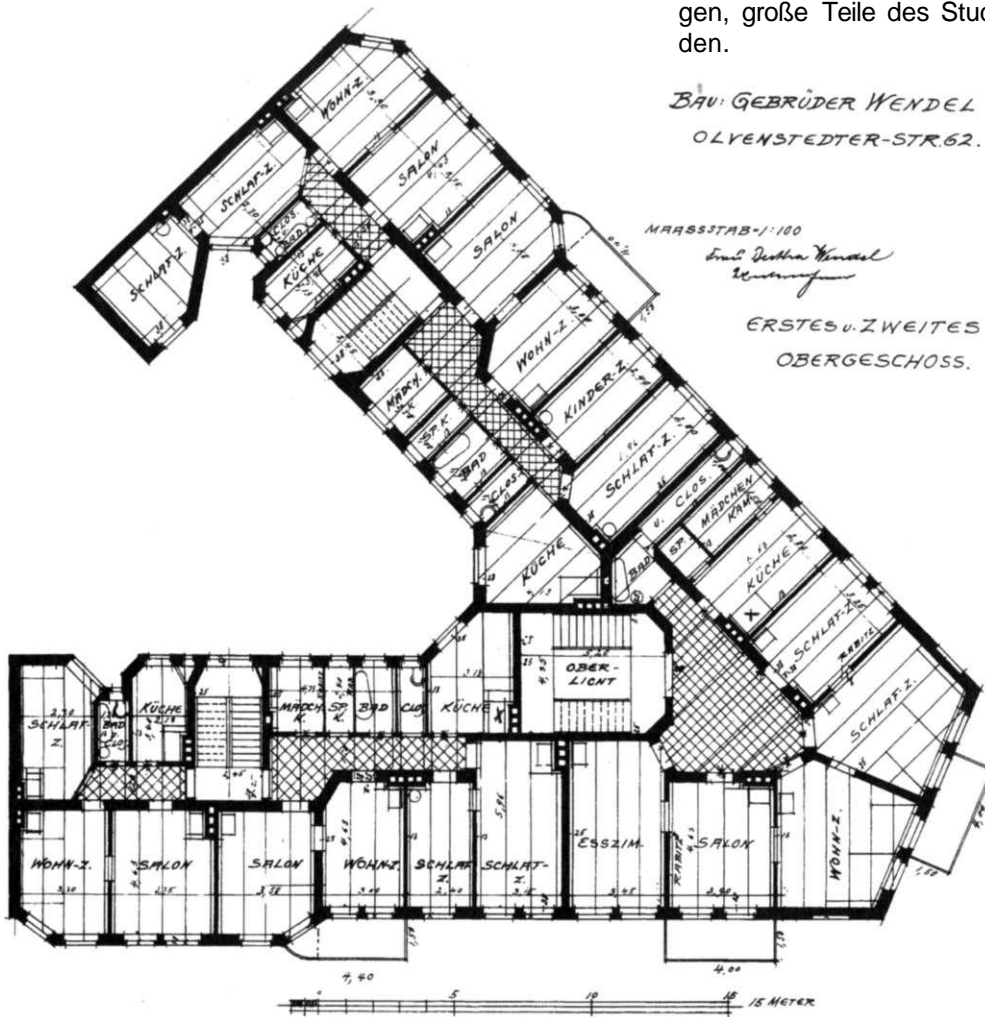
Olvenstedter Straße 62, Grundriß 1. und 2. Obergeschoß
